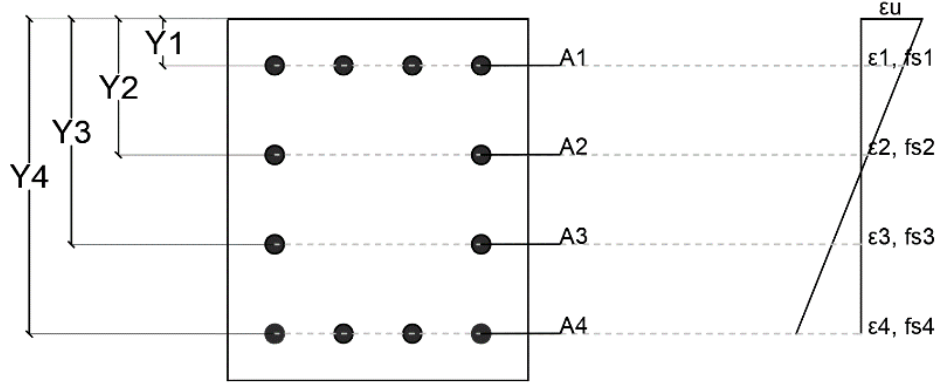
Sección transversal de un posible elemento de hormigón armado.
